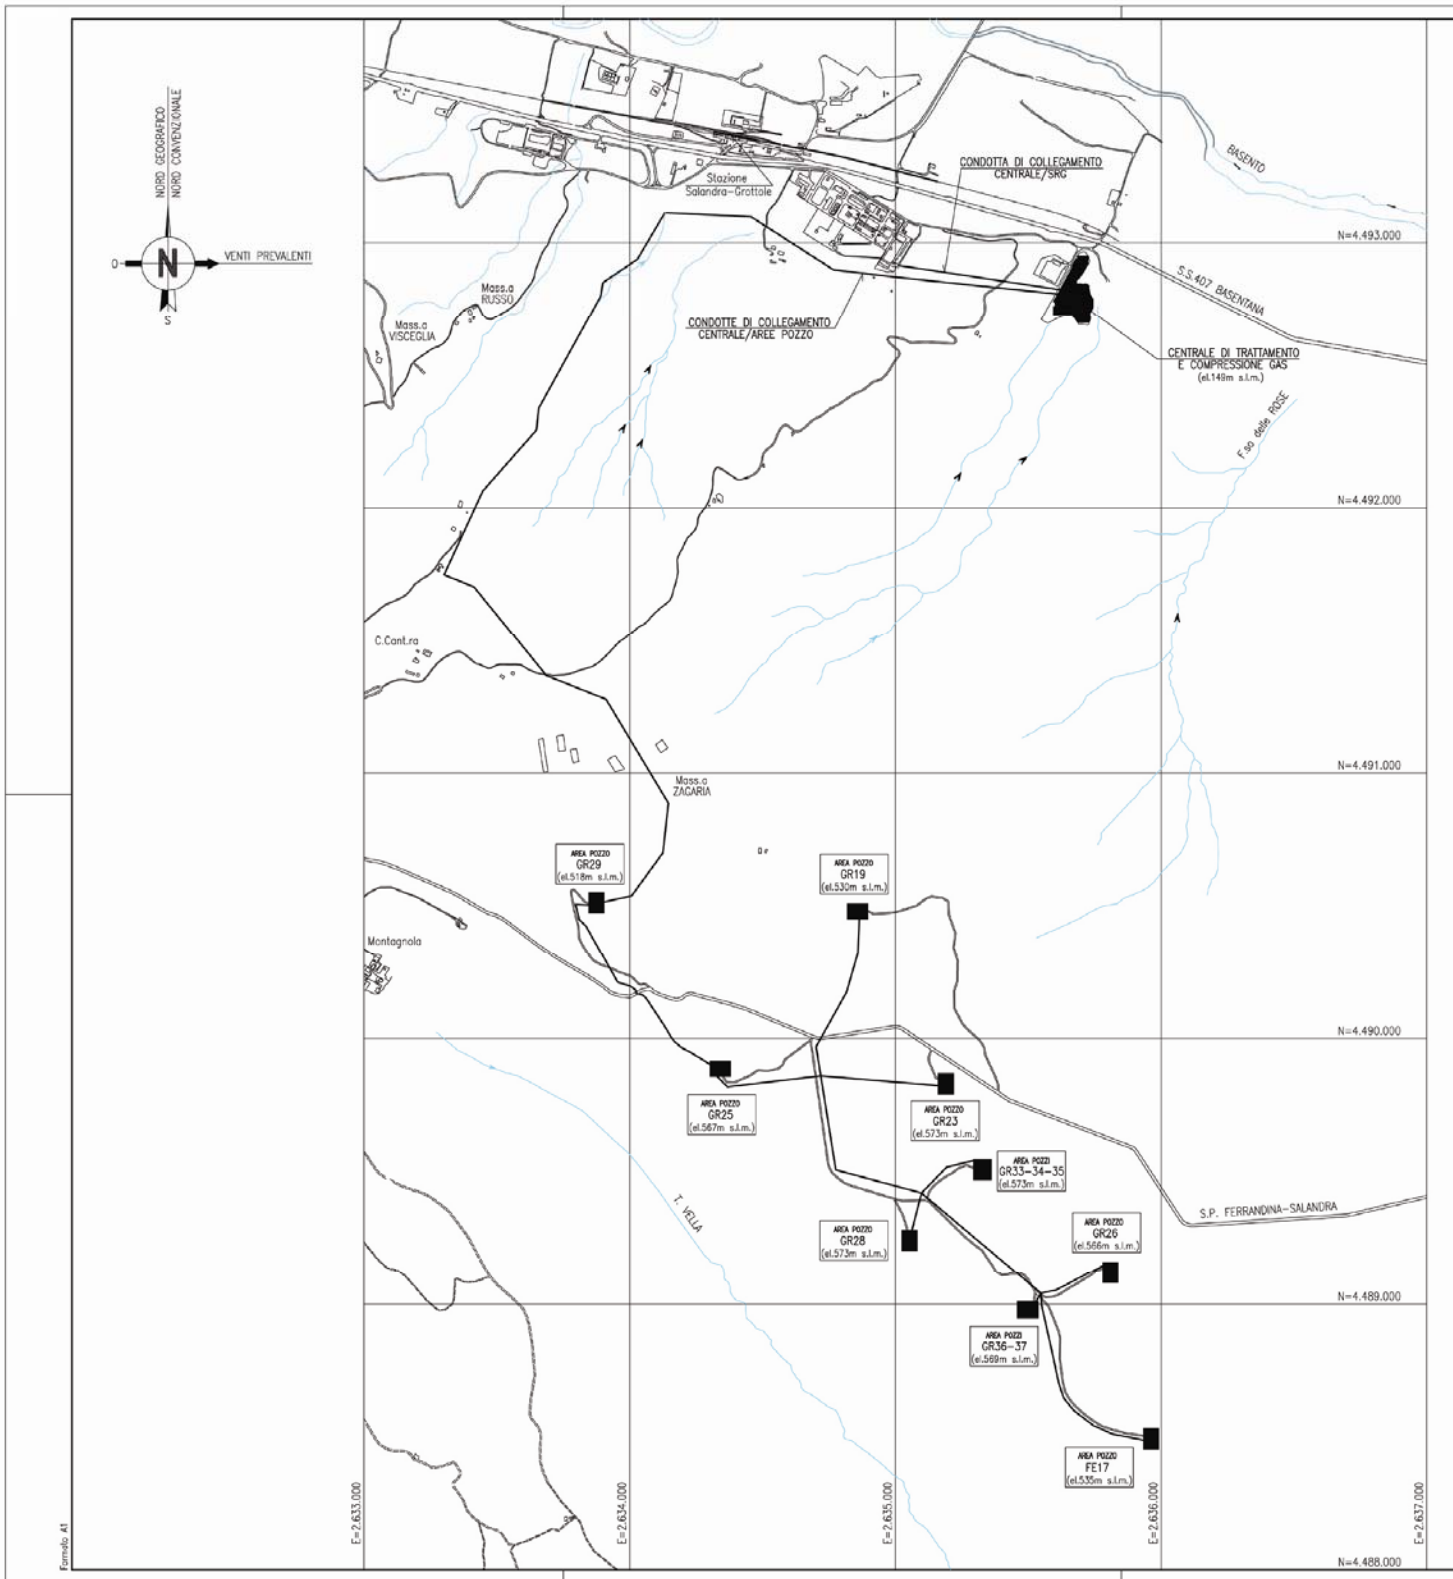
Stralcio planimetrico con ubicazione del metanodotto di collegamento tra il campo di Grottole/Ferrandina e la Centrale di Compressione/Trattamento
